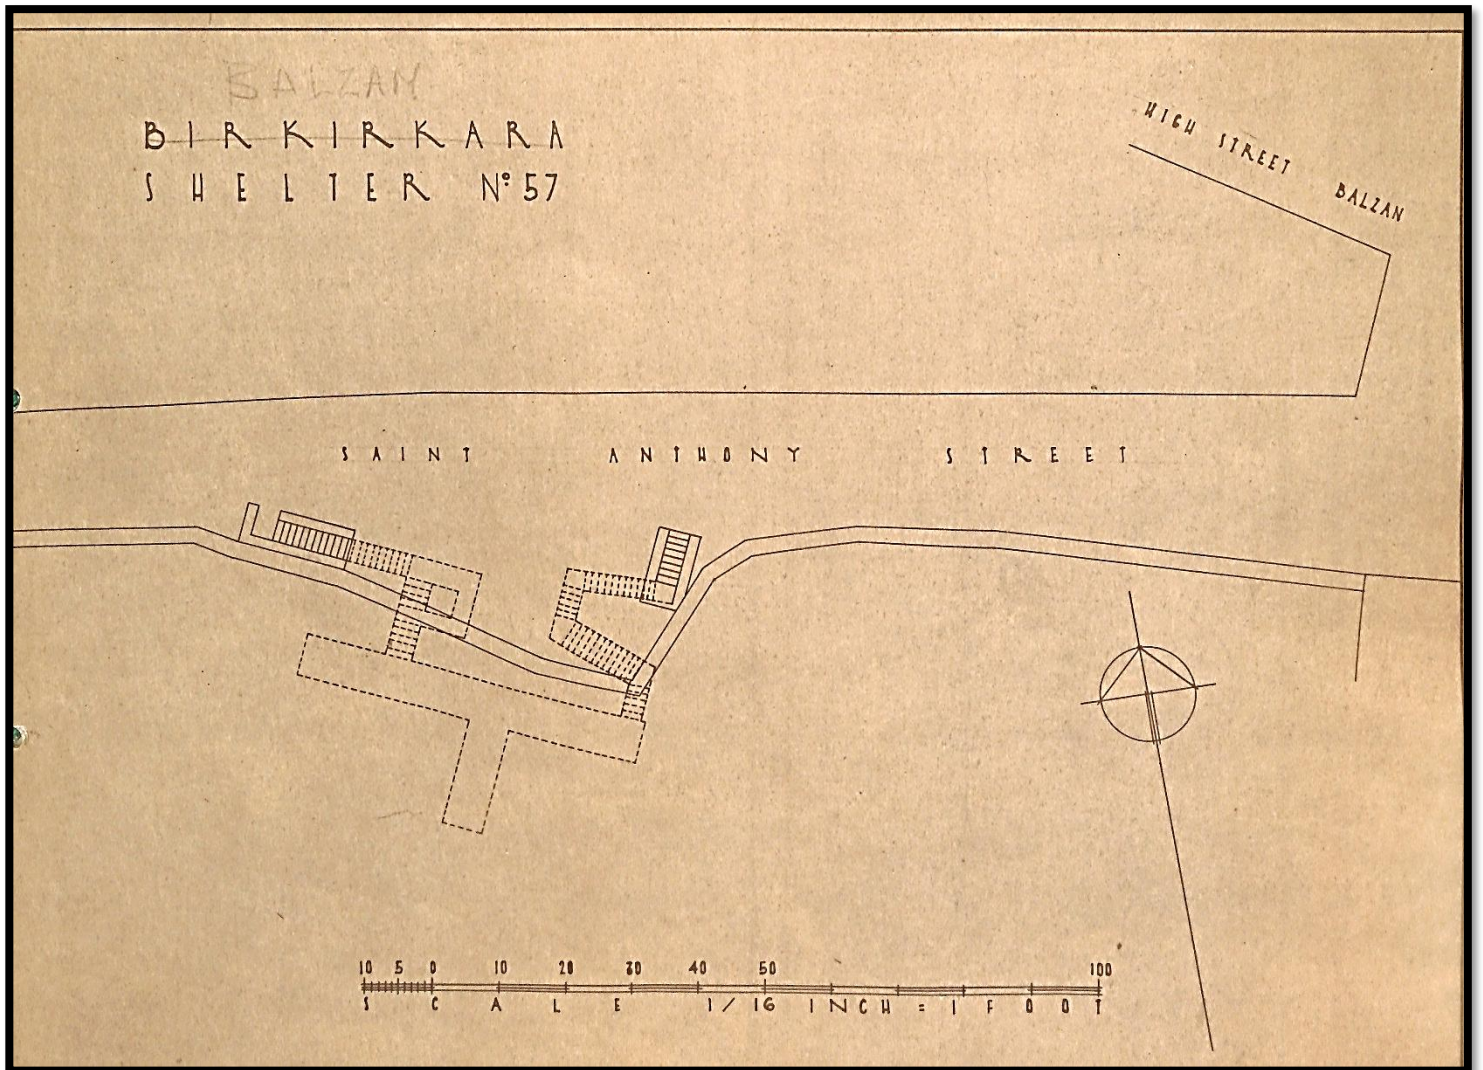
Planta do Abrigo nº 57 "Saint Anthony Street – High Street Balzan."
